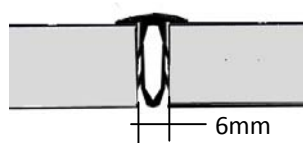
5mm Fuge mit T-Profil zum Einkleben.
